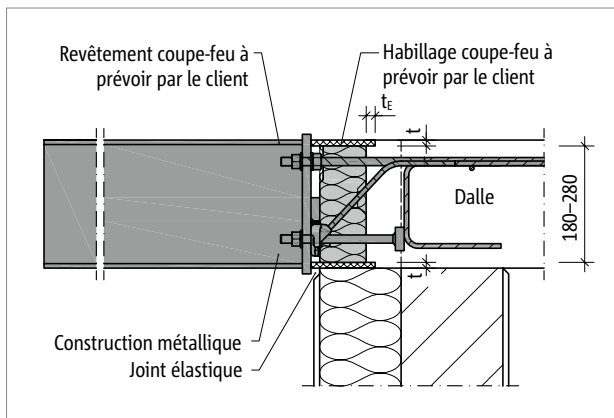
Schöck Isokorb® T type SK : Bardage de protection incendie sur site - T type SK, construction en acier avec revêtement de protection incendie ; coupe
